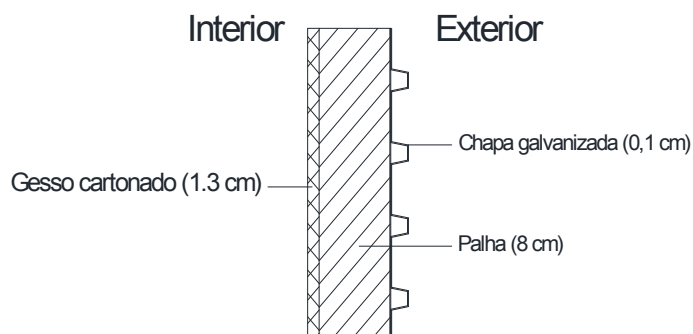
Parede exterior em chapa galvanizada e gesso cartonado
